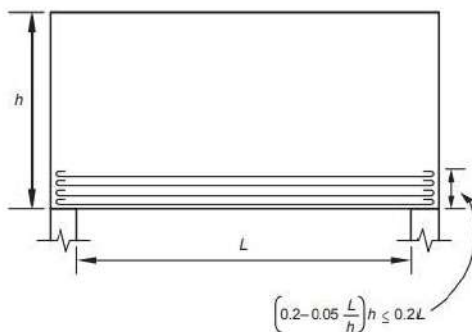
Disposición del refuerzo de flexión en una viga de gran peralte de un claro
